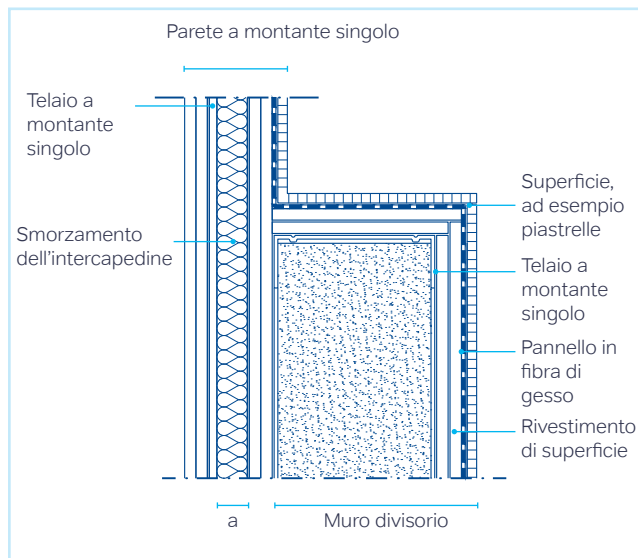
Parete a montante singolo con installazione aggiuntiva di muro divisorio
